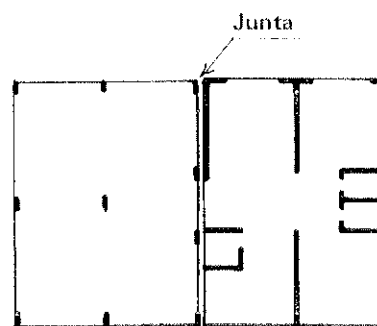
Junta en planta para separar una zona flexible de otra rígida.
